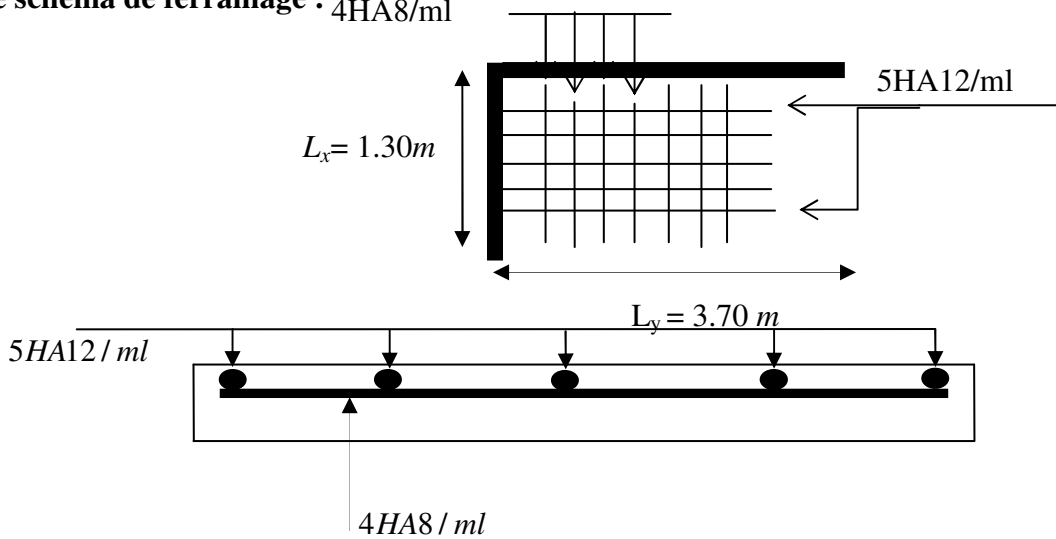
Schéma de ferrailage de la dalle pleine type2
